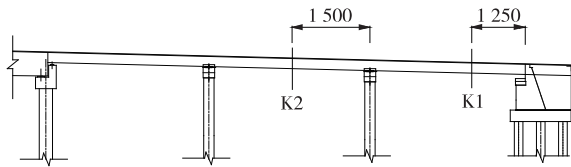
3×30 m T梁桥验证截面布置示意图(单位:cm)
